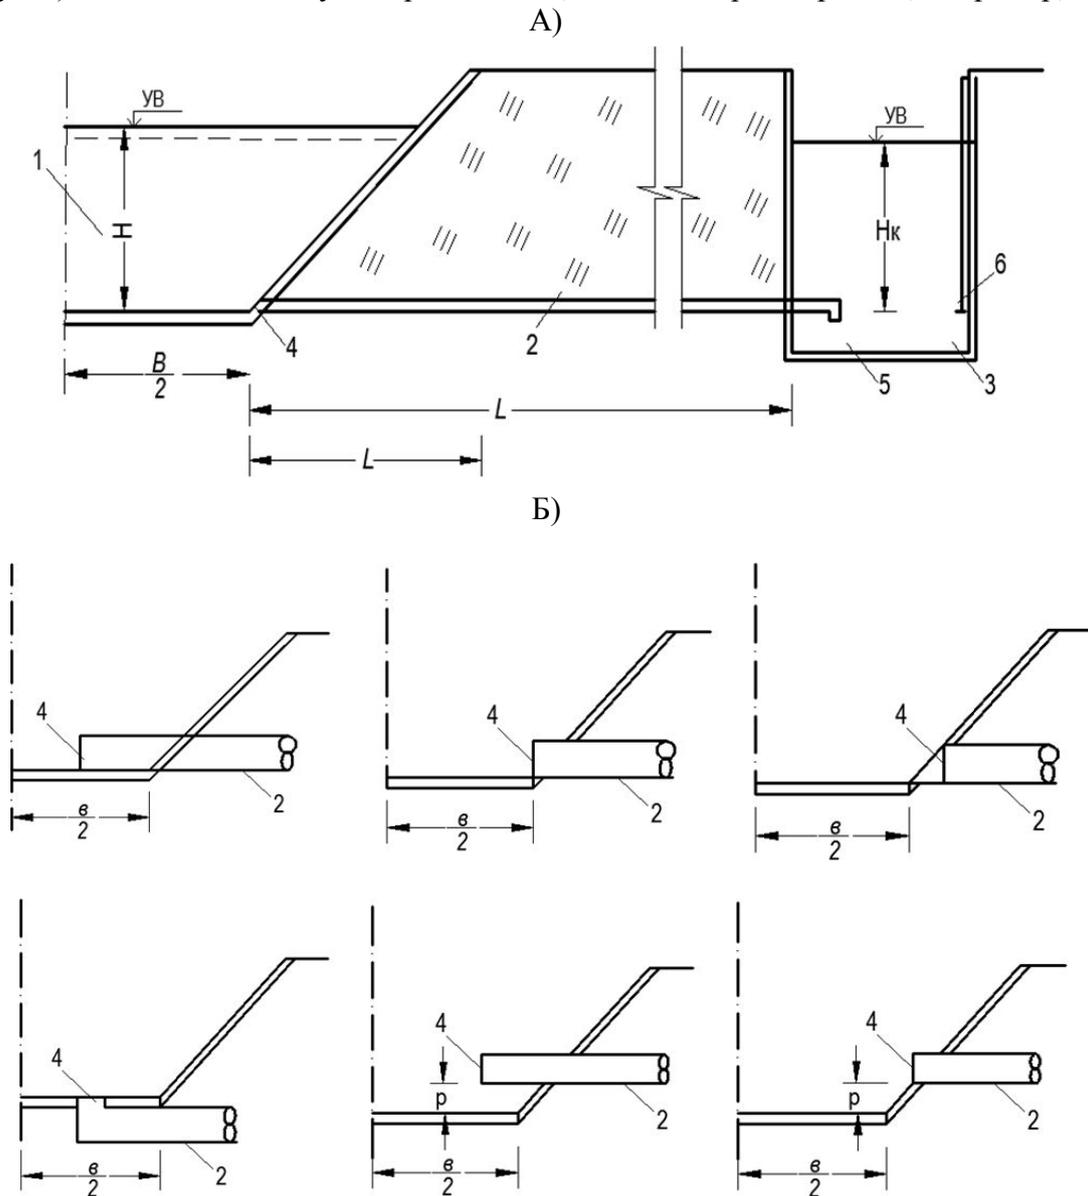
А – схема компоновки водотока с уровнемерным колодцем при помощи соединительной трубки; Б – схема размещения головной части соединительной трубки в водотоке.
